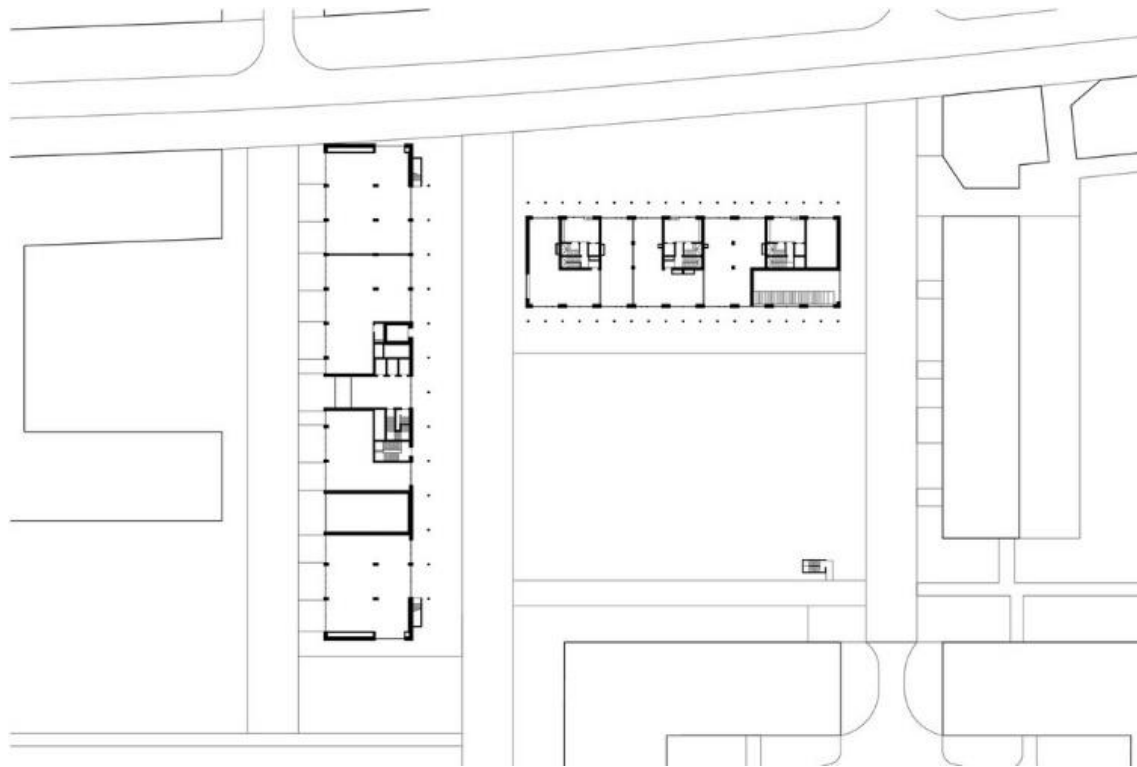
Planta Baixa, Piso Térreo. Fonte: <https://davidchipperfield.com/projects/nieuw-zuid-residential-and-office-buildings>
